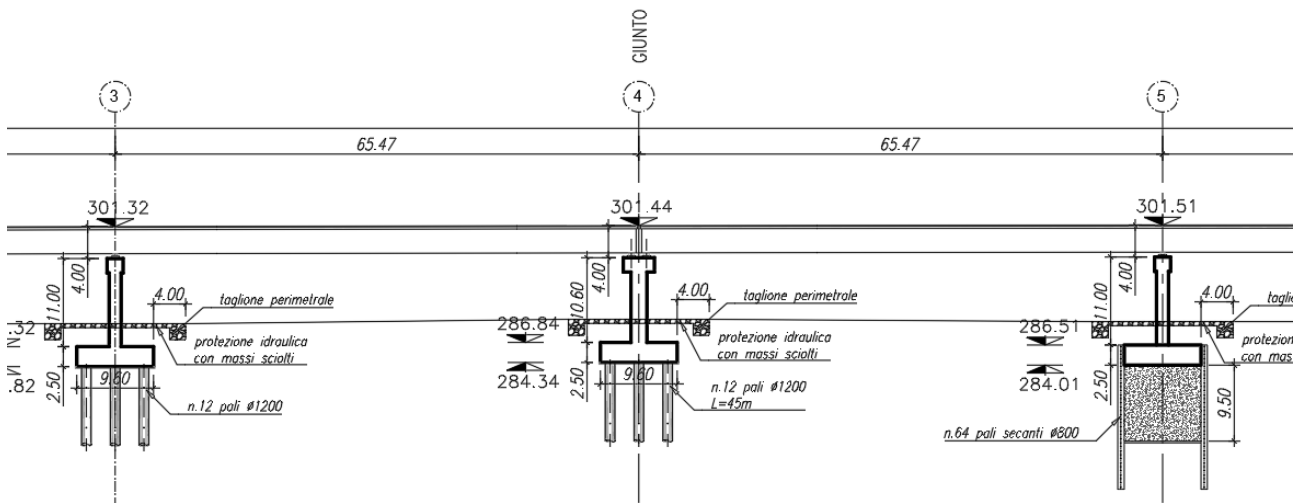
Esempio di pile di transizione con giunto strutturale e stradale
